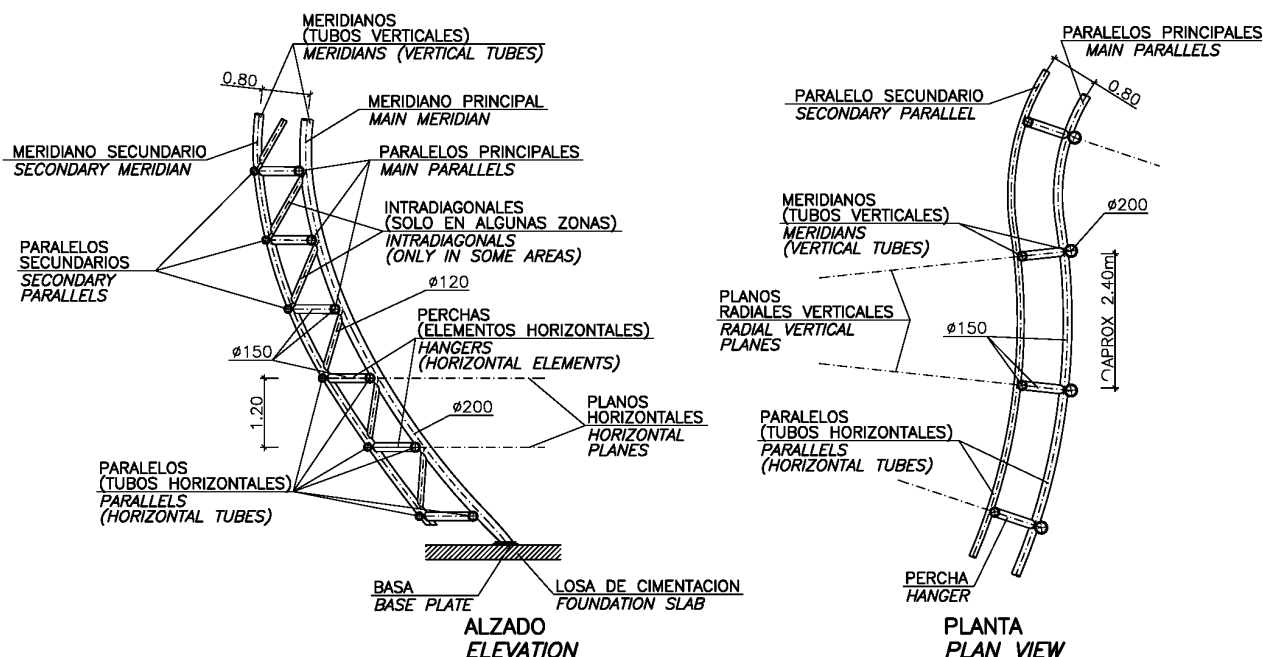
Estructura de fachada, compuesta por una doble malla ortogonal de tubos curvos. La malla principal se extiende hasta la cimentación, mientras que la malla secundaria se vincula a la principal por medio de “perchas”, y en algunos casos, “intradiagonales”.
